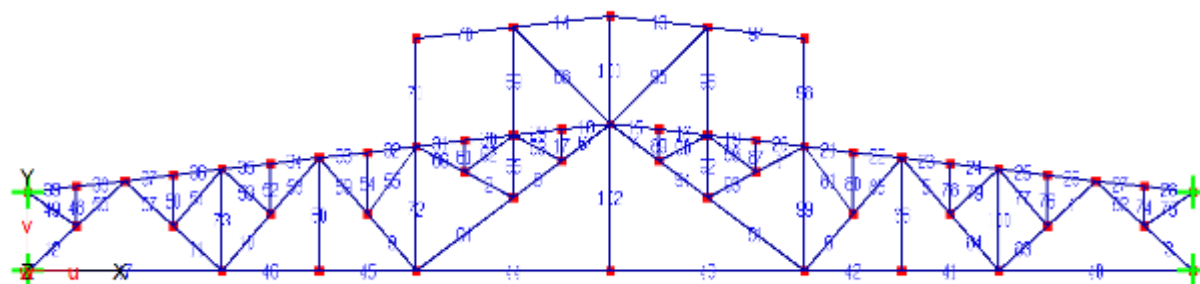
Расчетная схема стропильных ферм пролета «Ф'-Р'» в осях «21'-73'»
